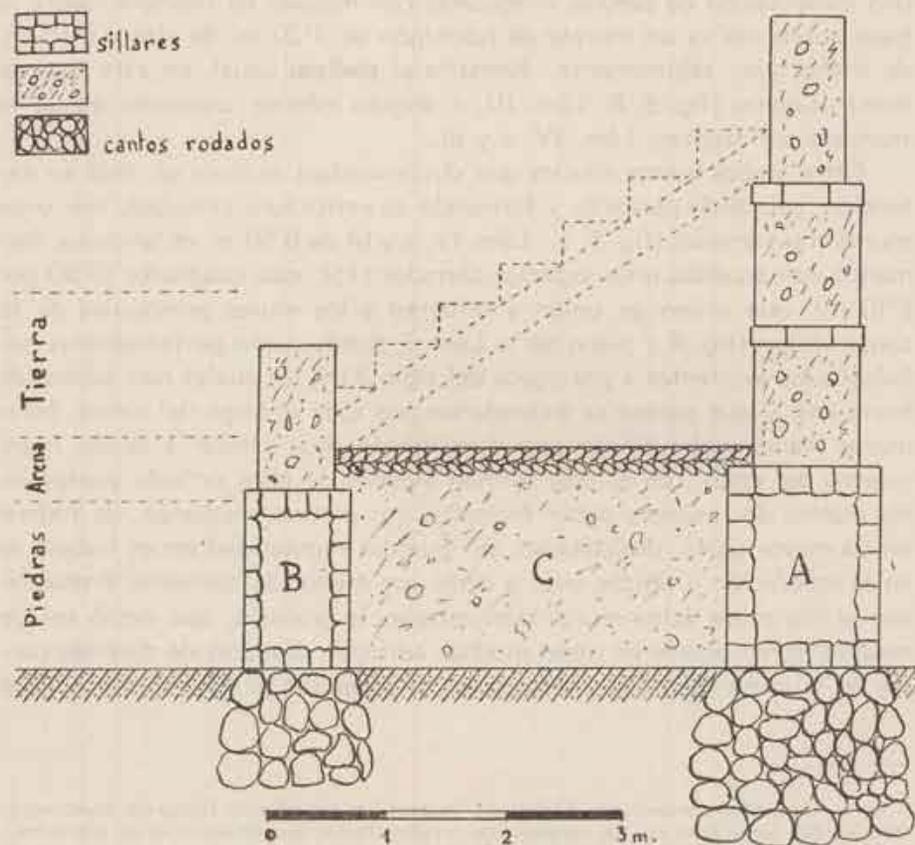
Sección de los muros exterior (A), interior (B) y transversal (C), con la reconstrucción hipotética de la gradería.
